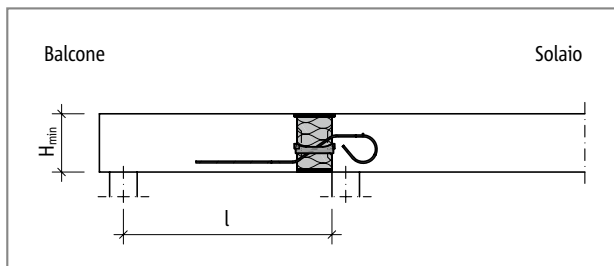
Schöck Isokorb® XT tipo QL: schema statico (XT tipo QL-V1 - V4)
